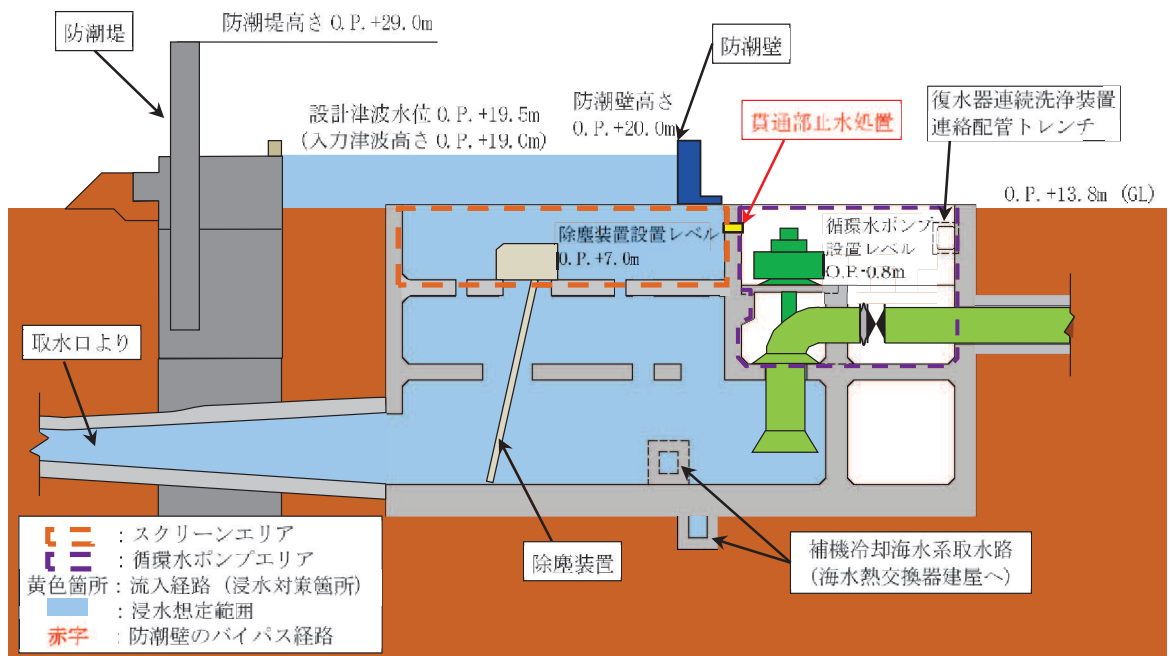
(2) 第 3 号機 海水ポンプ室 流入対策配置図 (A-A 断面図)
